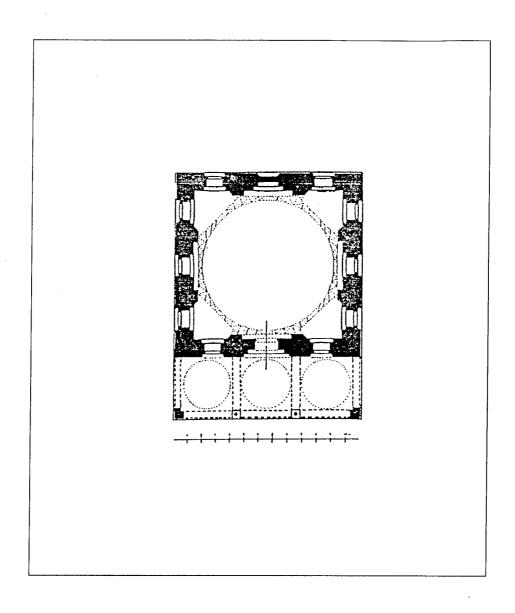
مسقط أفقي لمسجد الياس بك في كورتزه (عن : كيل) .
